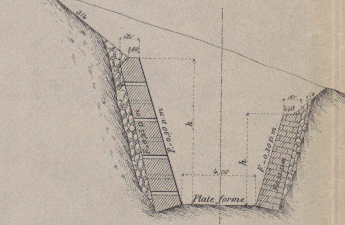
Mur de soutènement en maçonnerie de mortier pour remblai.
